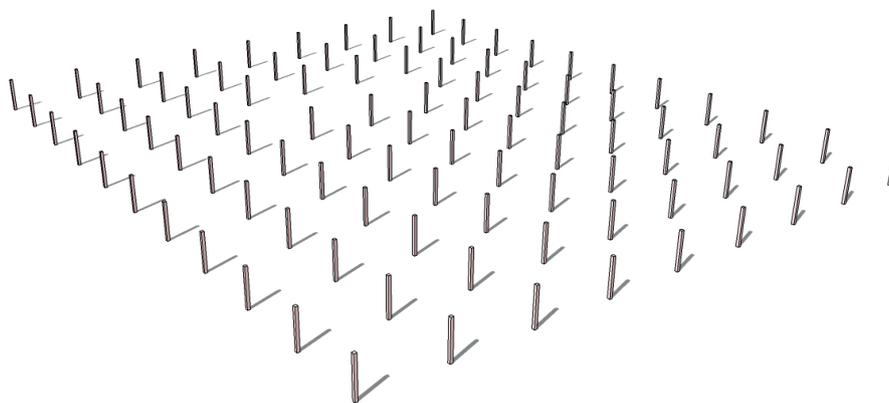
Modulação pilares Tipo FONTE: Autora.
